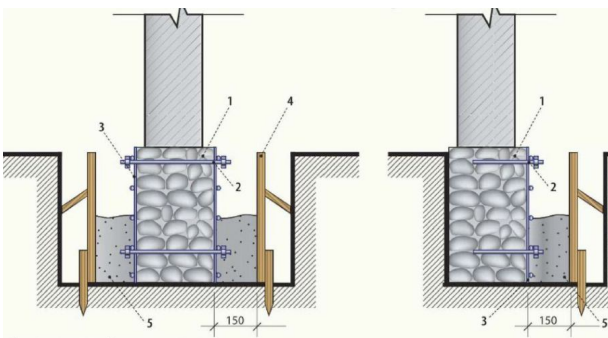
Підсилення фундаментів збільшенням площі опирання:
